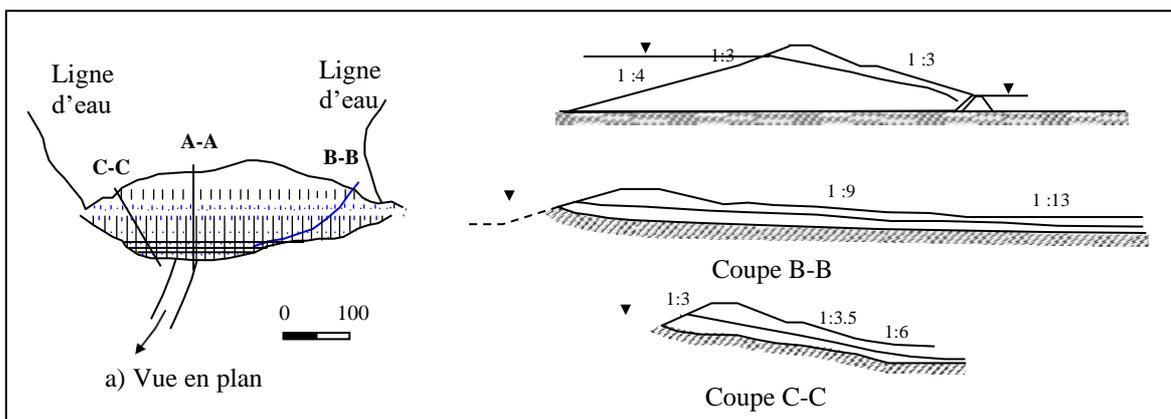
Schéma d'un barrage en terre (Grishin, 1982).
